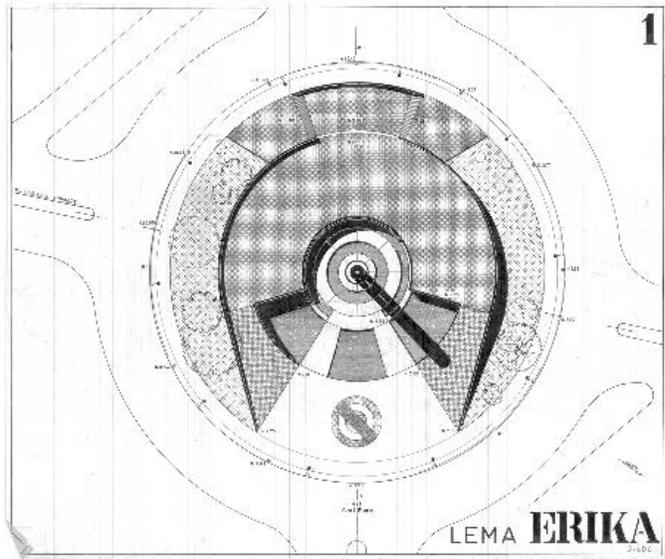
PLAZA DEL EJÉRCITO. ROBERTO ELZAURDÍA. PLANTA, PROYECTO DE 1974.
